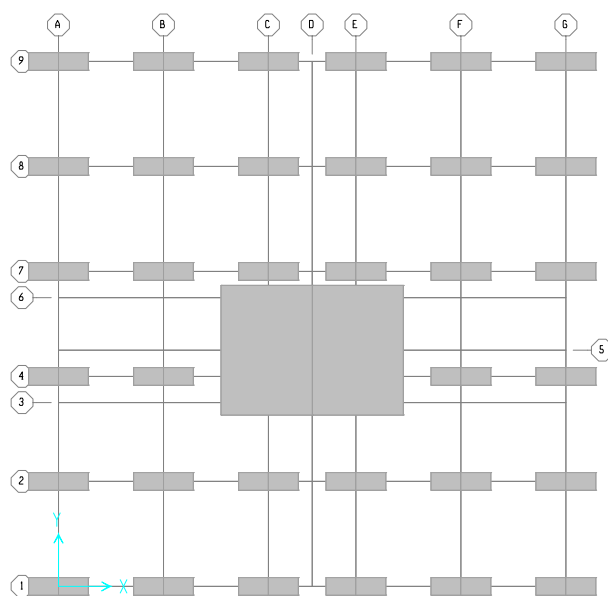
Esquema do alinhamento em planta do edifício tipo
